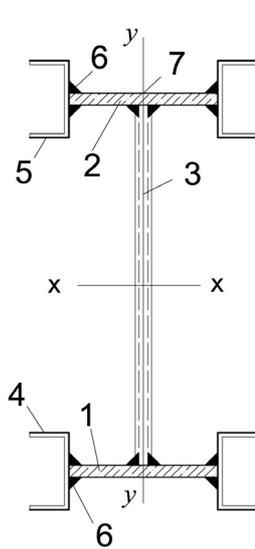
Сечение сварного двутавра стальной балки с гофрстенкой и элементами каркаса огнезащитных поясов
